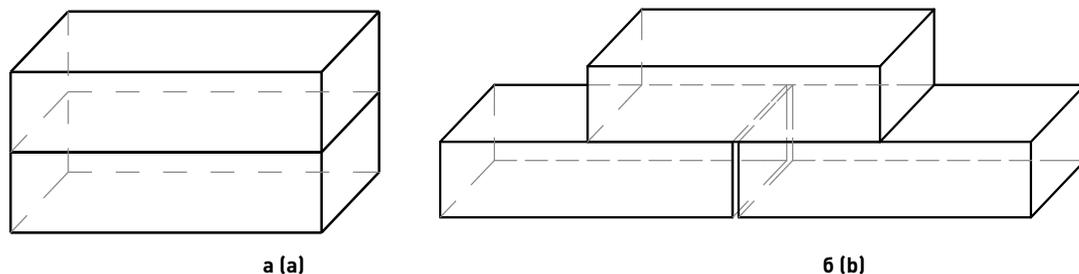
Кладка «насухо» при выравнивании опорных поверхностей методом шлифования: а – фрагмент кладки без перевязки; б – фрагмент кладки с перевязкой
